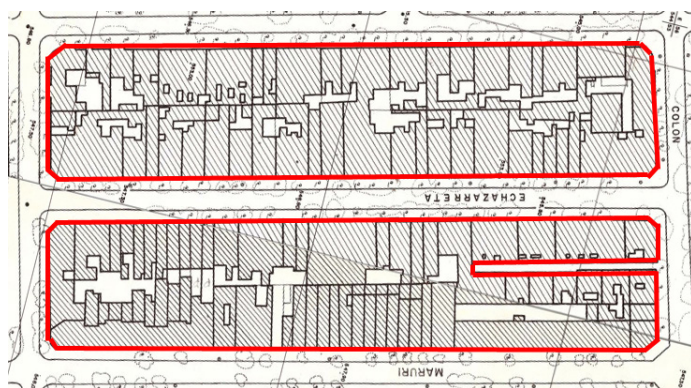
Planta conjunta. Elaboración propia a partir de Plano de Alcantarillado de Lía Ovalle, 1922.
